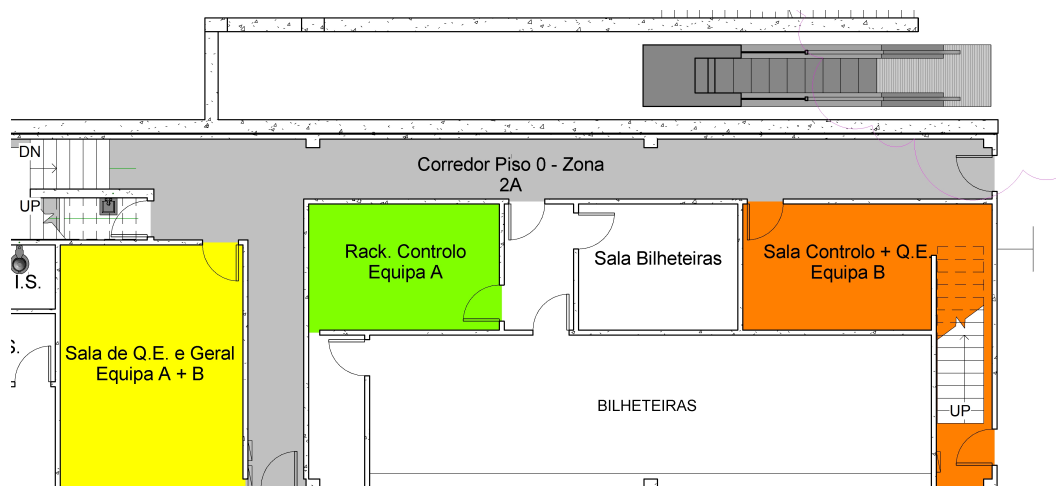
Planta de áreas relevantes a cada uma das equipas
